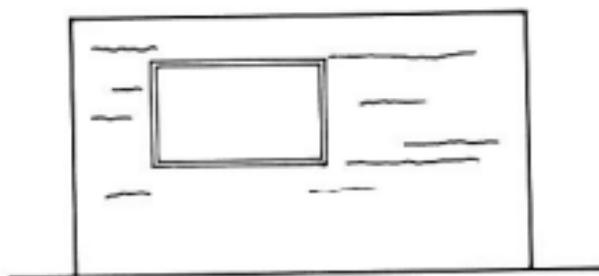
Fissuras horizontais no revestimento provocadas pela expansão da argamassa de assentamento.
